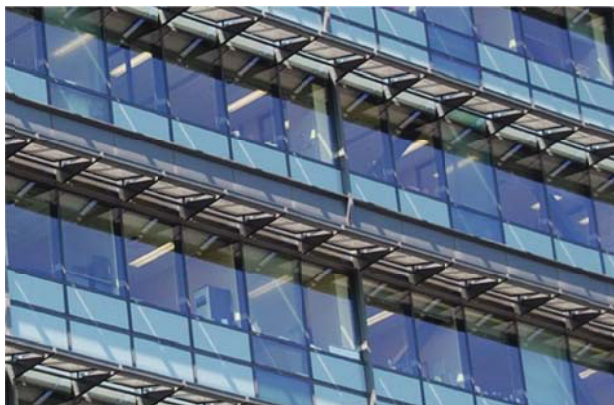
Schermature e pannelli solari nel prospetto sud.
